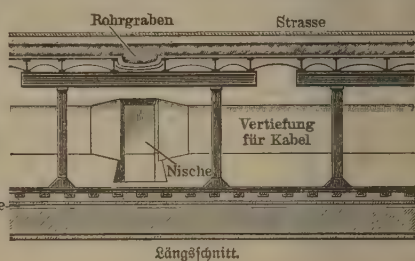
Tunnel der Berliner Untergrundbahn in der Niederwallstraße.
